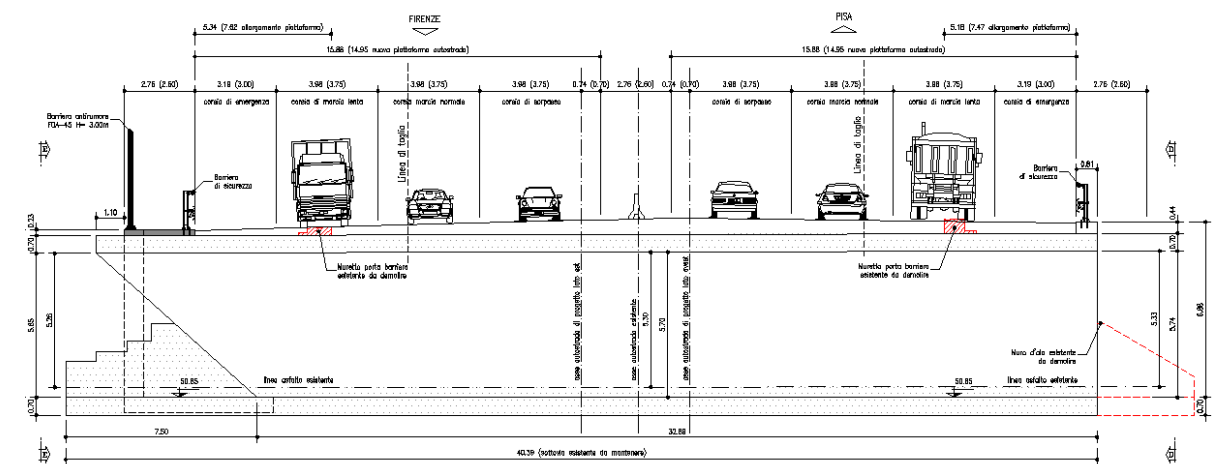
Sottovia via Bonellina II. Sezione trasversale
